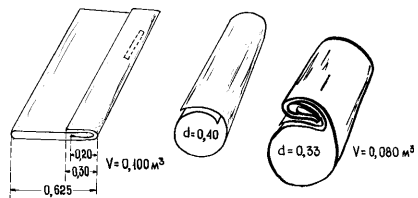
Сворачивание плащ-палатки для набивки ее материалами (второй способ)
